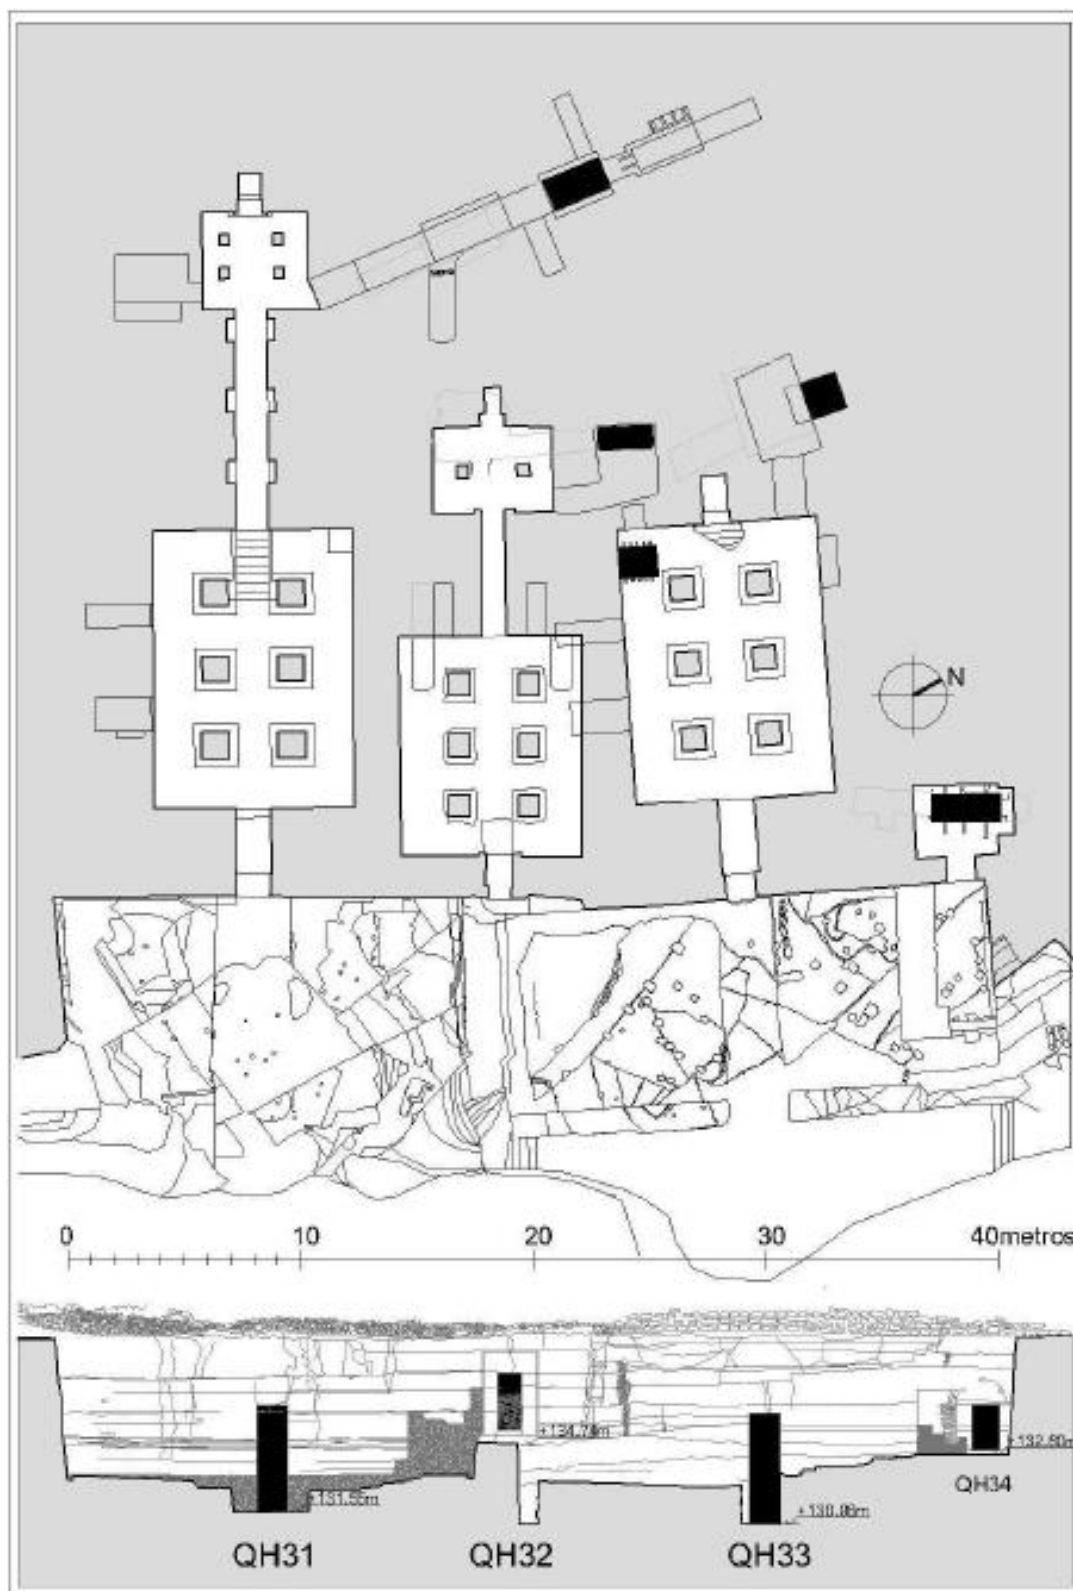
Plano en planta y alzado del exterior del conjunto funerario.¹
